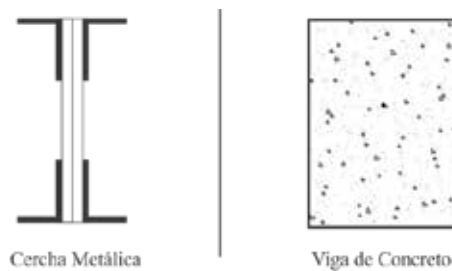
Secciones de vigas usadas en el proyecto. (2016)
